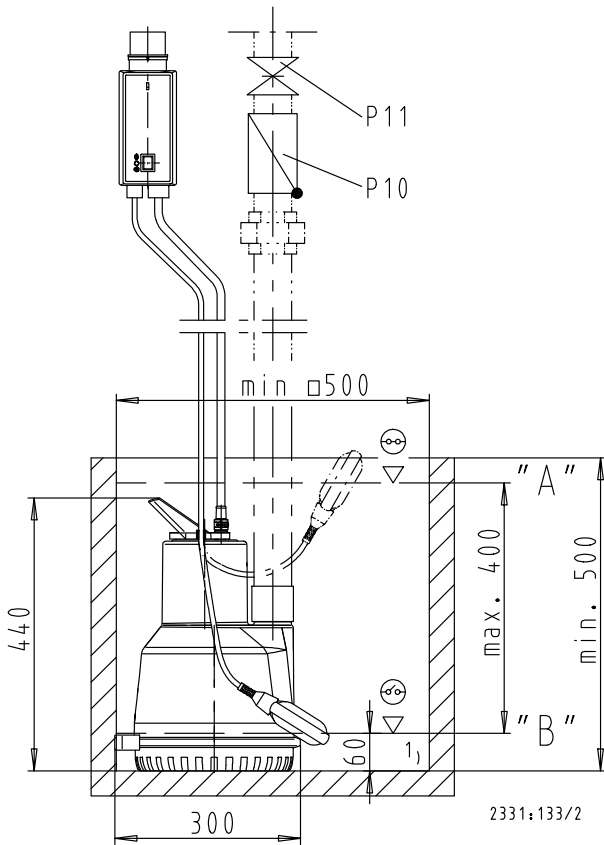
Ama-Drainer 4, Einzelpumpe, Kugeldurchgang 35 mm, mit Schwimmerschalter, Drehstrommotor, ohne Kühlmantel
